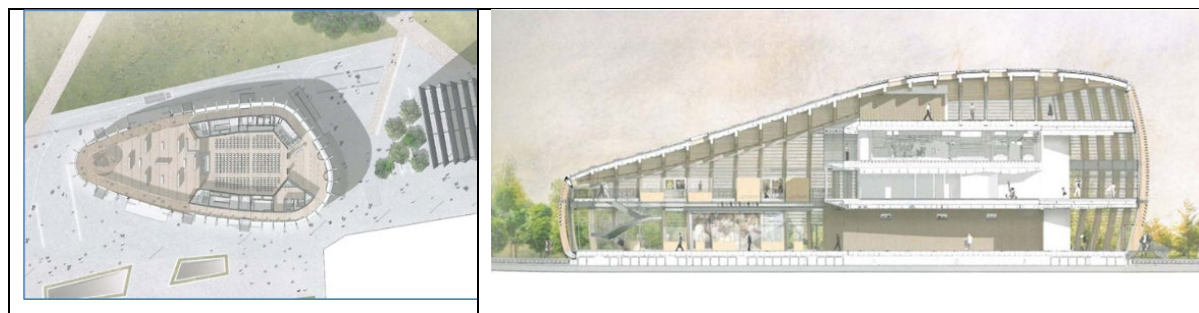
Pianta e sezione dell'UniCredit Pavillon
